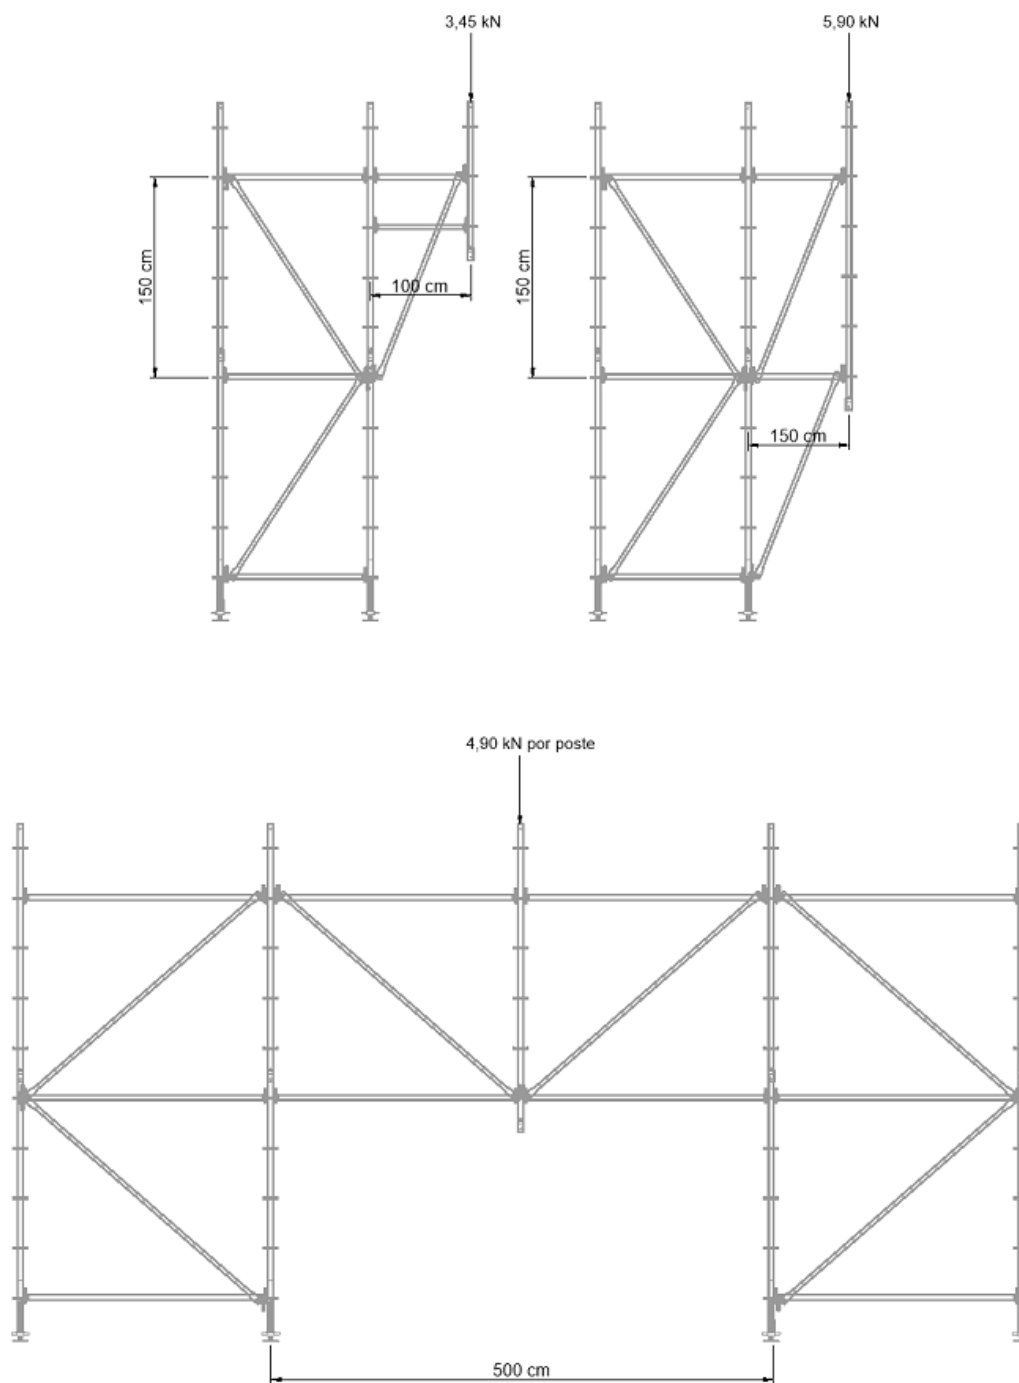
Exemplos de consolas Modex® SH e cargas atuantes
